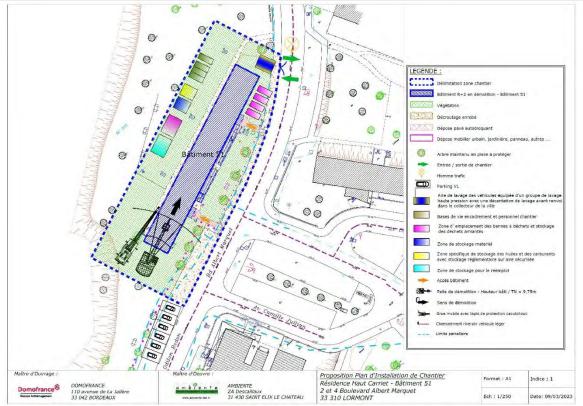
Exemple du plan d'installation de chantier du bâtiment 51 Source : Ambiente
